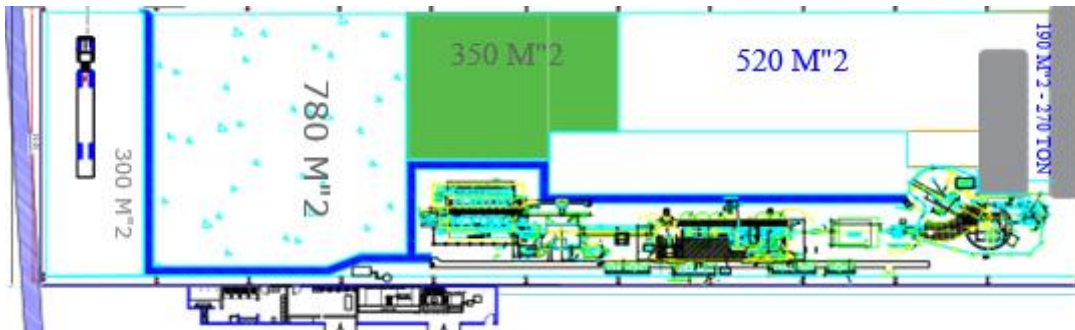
Áreas disponibles dentro de la planta (se recomienda ver anexo 3).
